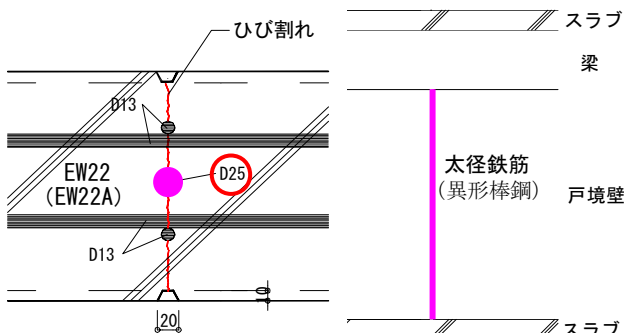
鉄筋挿入型ひび割れ制御工法 (縦断面・設置範囲)
